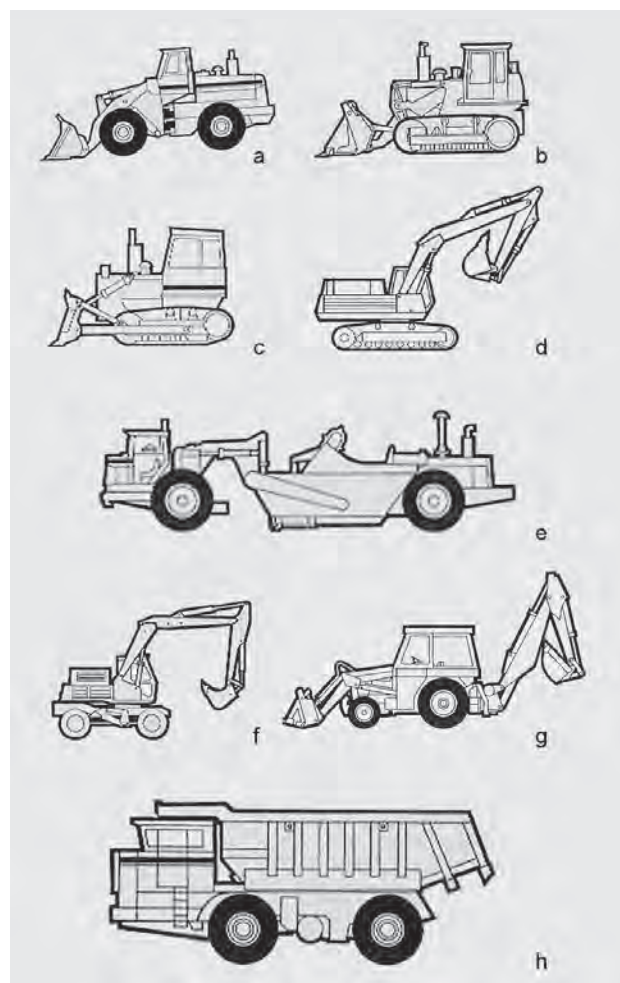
Die wichtigsten Erdbewegungsmaschinen/ Flachbagger: a. Radlader, b. Laderaupe, c. Planierraupe, d. Hydraulik-Raupenbagger, e. Elevator- und Schubscraper, f. Hydraulik-Mobilbagger, g. Baggerlader, h. Muldenkipper LKW, sog. Dumper
